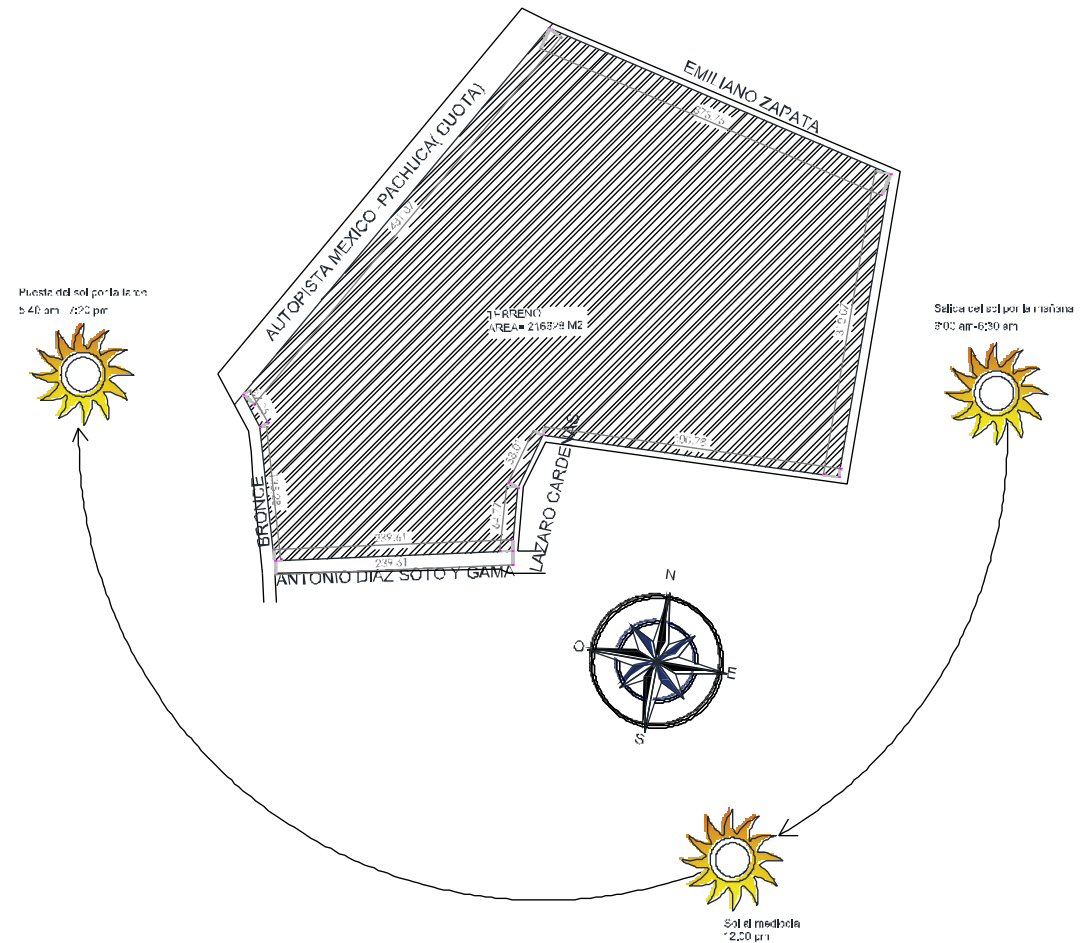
Orientación del terreno para el proyecto arquitectónico
